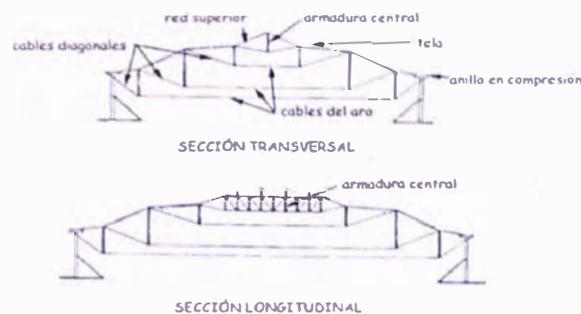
Tomado de: Fuller Moore, Libro: Compresión de las Estructuras en Arquitectura, Georgia Dome secciones.
